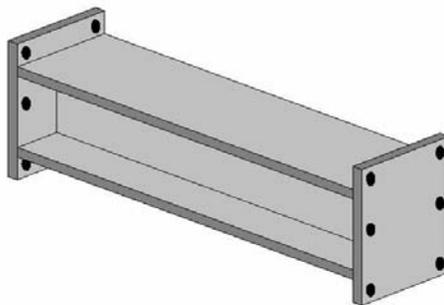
Alargaderas Sistema Paralelo Apernables./Elaboración Propia.
